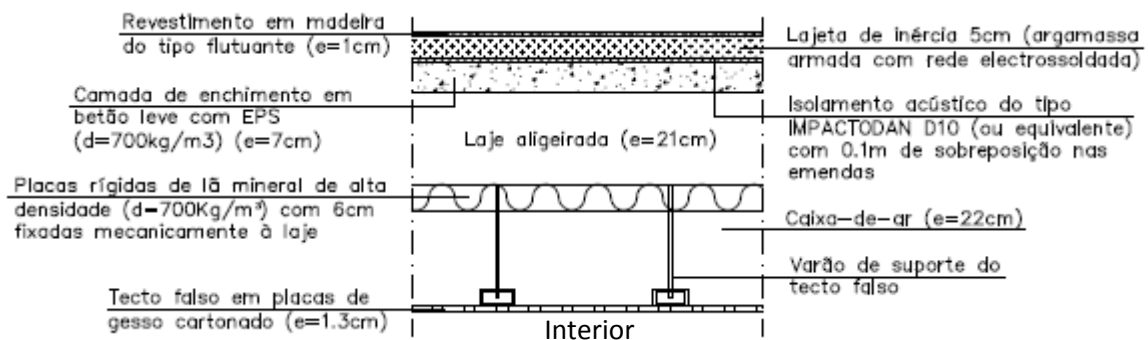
Pormenor construtivo do pavimento 1 [17]
